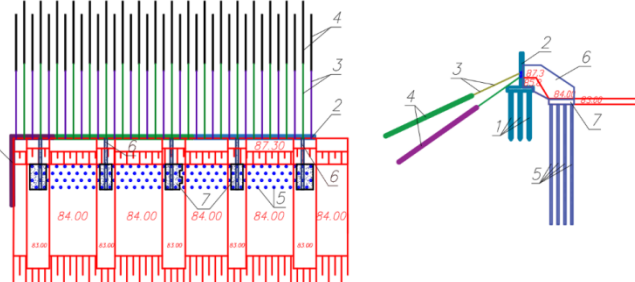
Вертикальная привязка свайных фундаментов в инженерно-геологический разрез: 1 – свайное основание из призматических железобетонных свай под существующий 2 монолитный железобетонный уголковый ростверк; 3, 4 – грунтовые анкеры ЭРТ (3 – анкерная тяга; 4 – корень анкера); 5 – буронабъекционные сваи ЭРТ усиления основания; 6 – монолитные железобетонные контрфорсы; 7 – монолитный железобетонный ростверк; 8 – пристенный линейный дренаж
